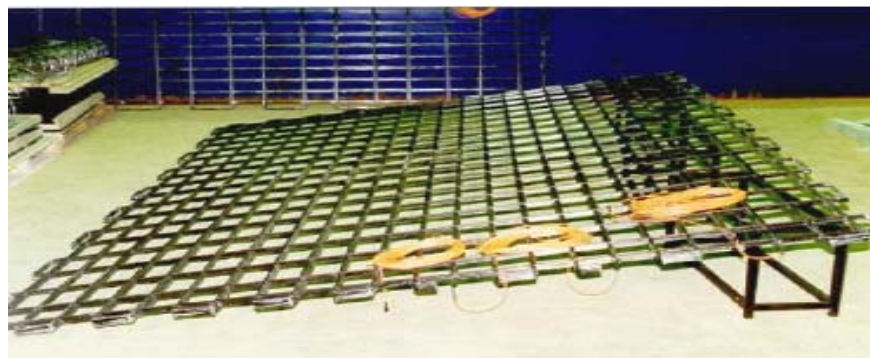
Emparrillado monolítico en traveses y losas por Dr. en Ing. Aftab Mufti
